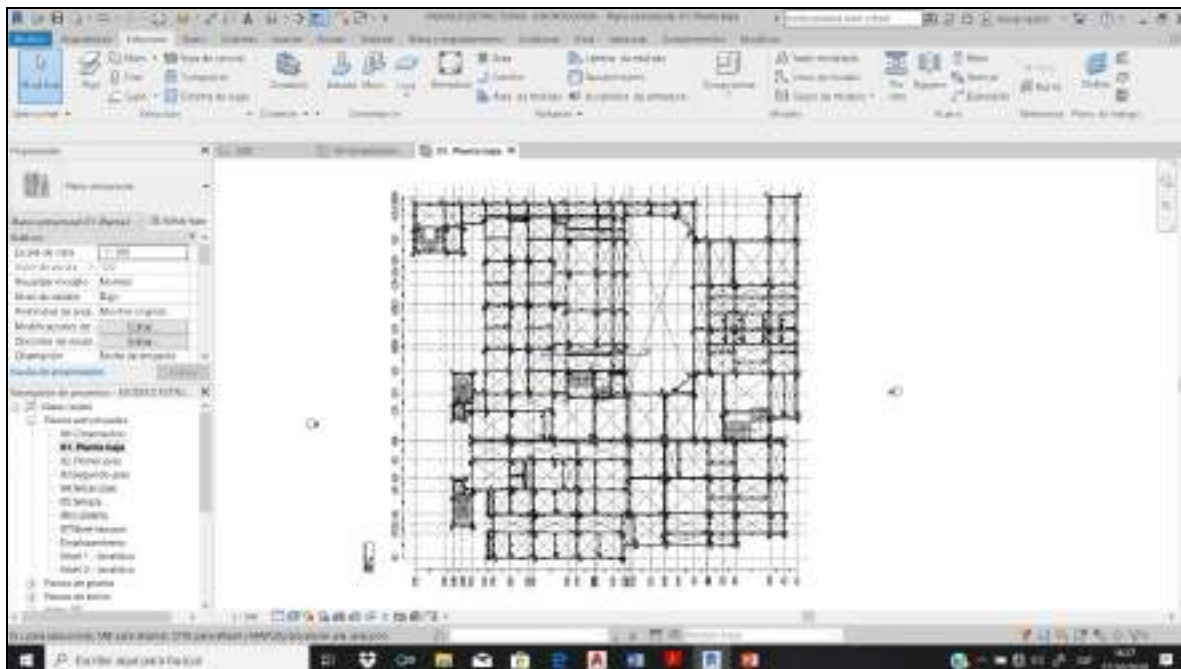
Revit- Importación de plano de Vigas de sobre cimientos
